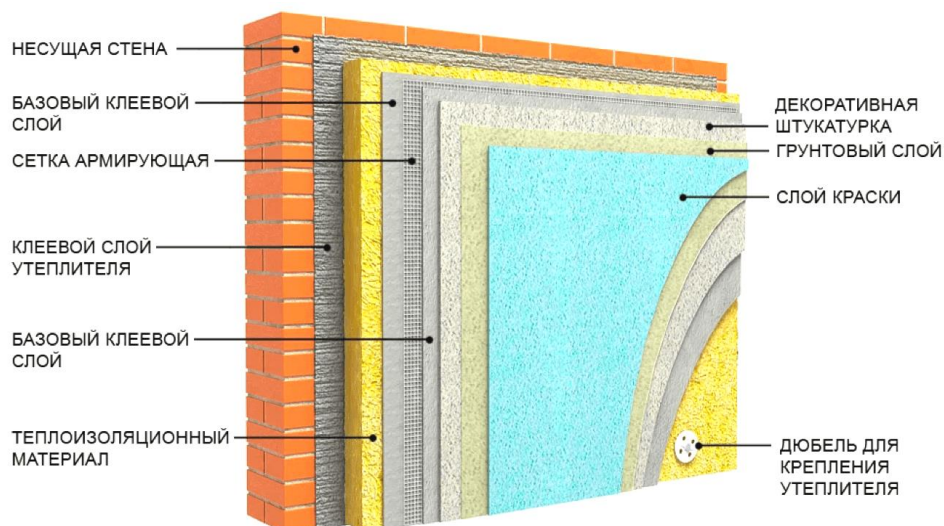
Утепление наружных стен кирпичного многоквартирного дома
